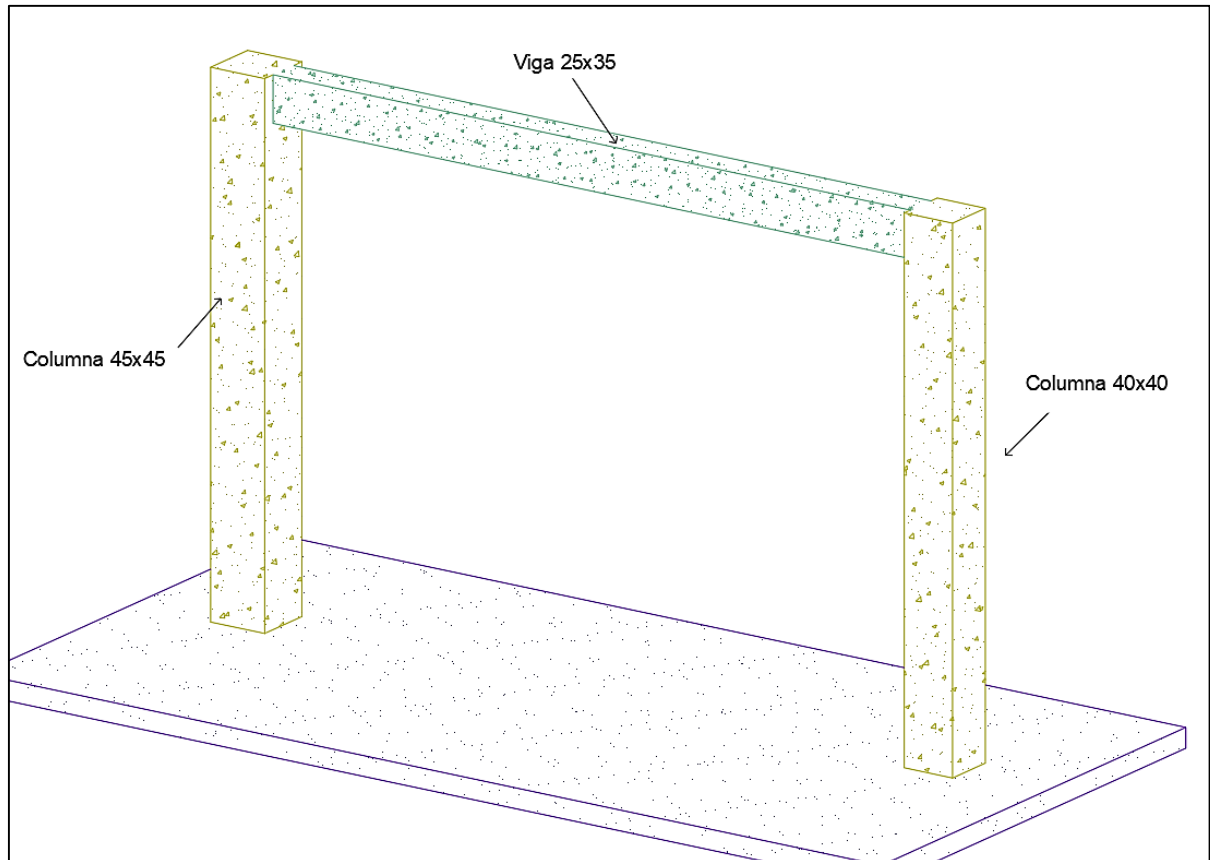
Pórtico seleccionado, vista en 3D. Viga y Columnas F7 y F9
